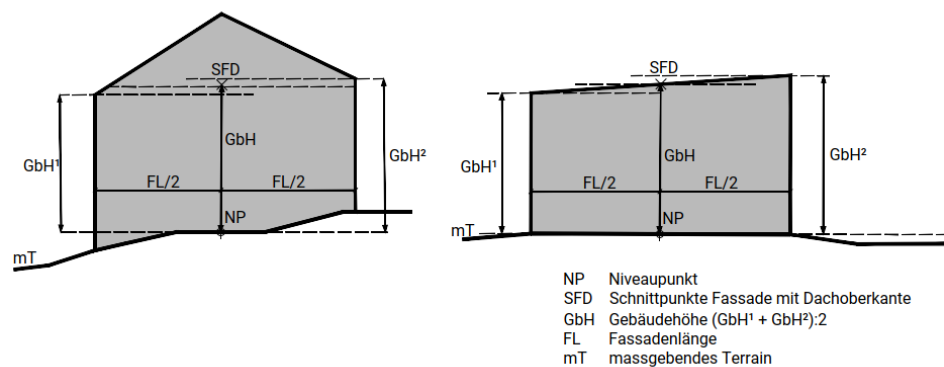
Ausgemittelter Schnittpunkt Fassade mit Dachoberkante bei unterschiedlichen Traufhöhen
